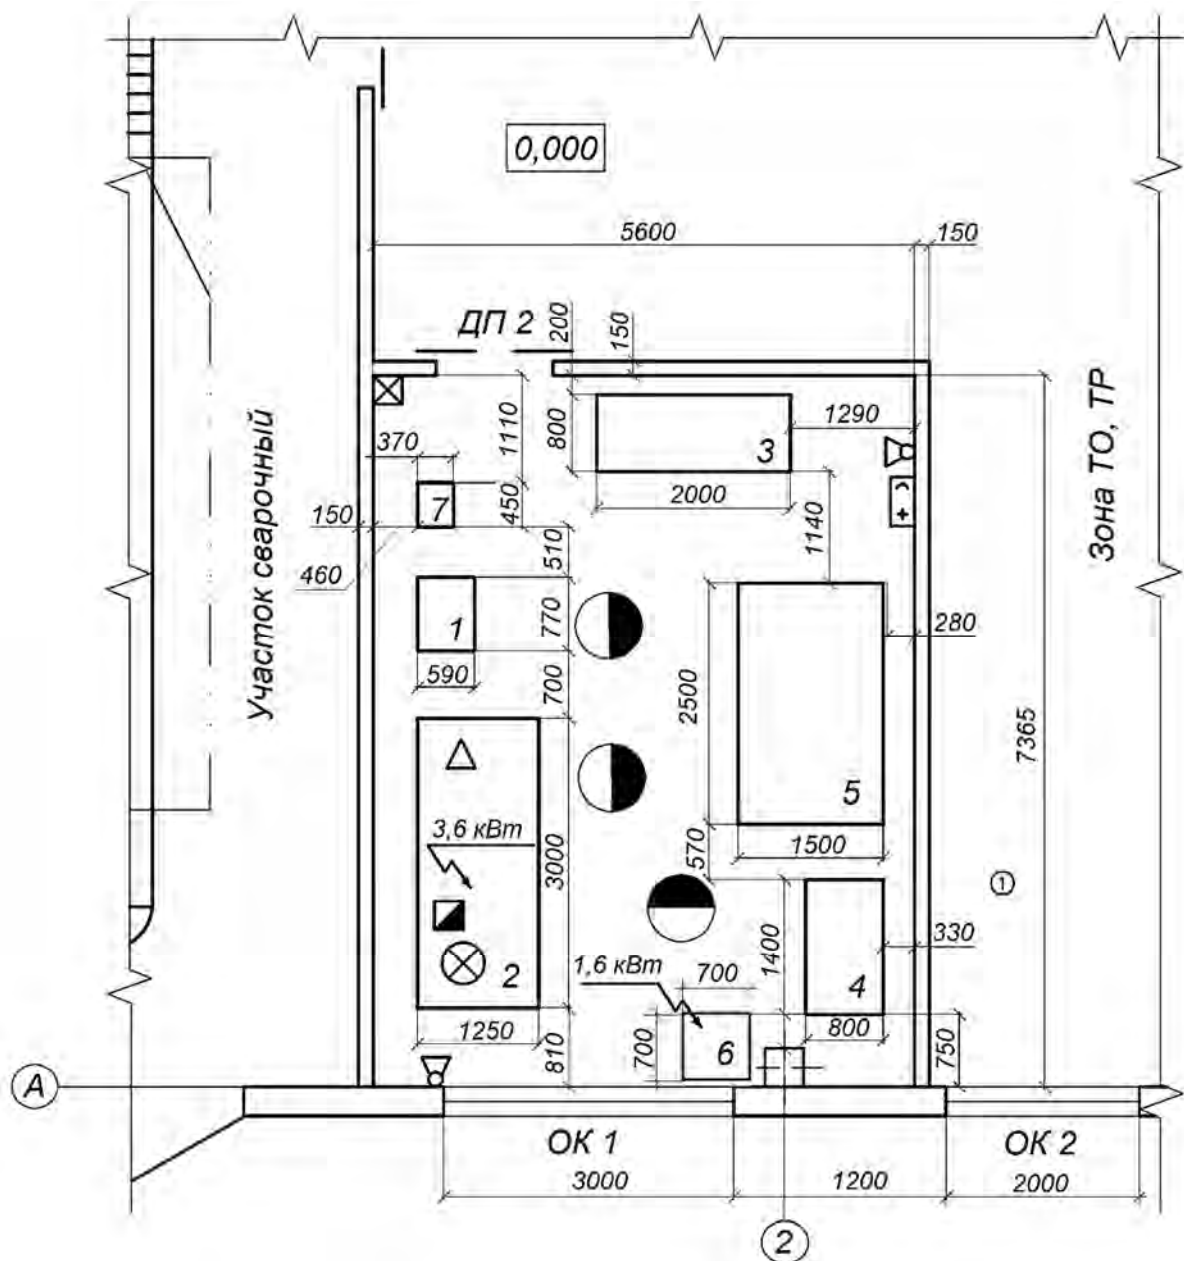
Планировочное решение медницкого участка: 1 – стенд испытания герметичности трубопровода; 2 – стенд для ремонта радиаторов; 3 – стеллаж для топливных баков; 4 – верстак медницкий; 5 – стеллаж для радиаторов; 6 – печь муфельная; 7 – пресс ручной
